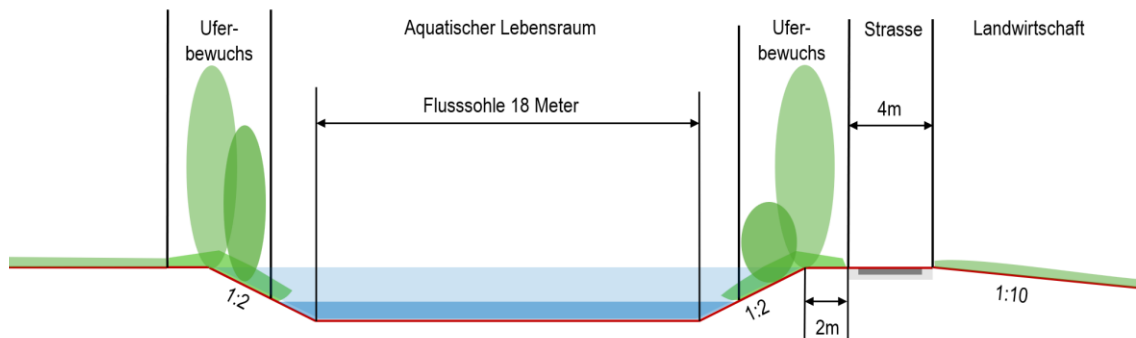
Technisches Querprofil Seez mit generalisierter Abmessung
